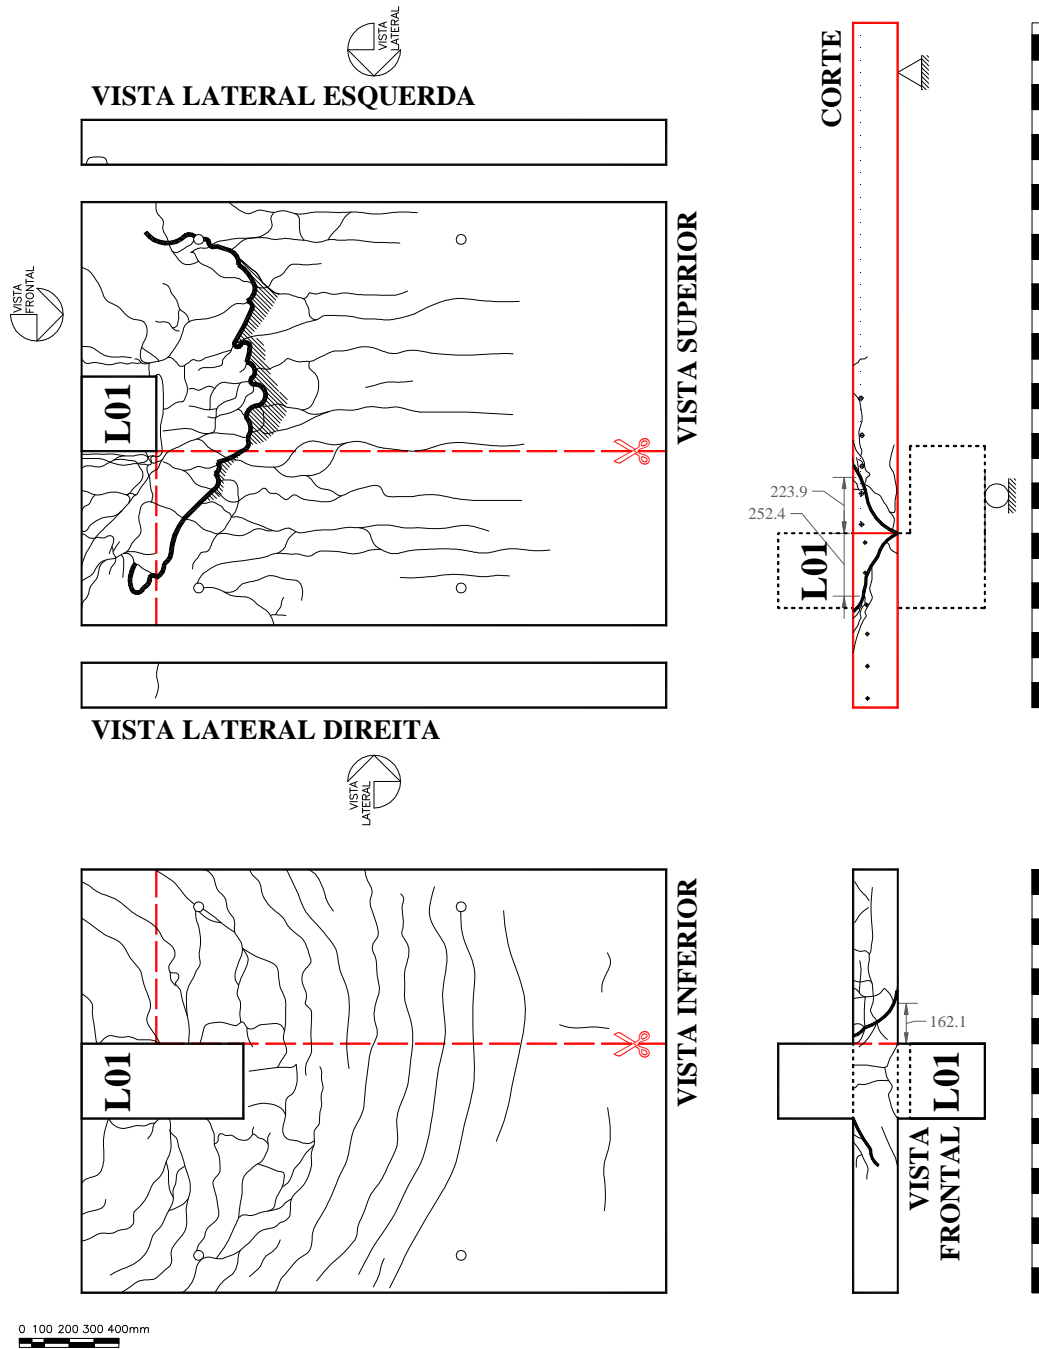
Padrão de fissuração da laje L01
